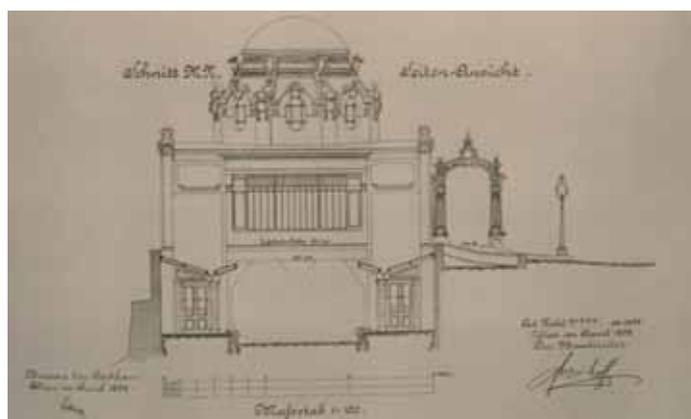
Sección y alzado lateral del Hofpavillon de Otto Wagner (1898)
